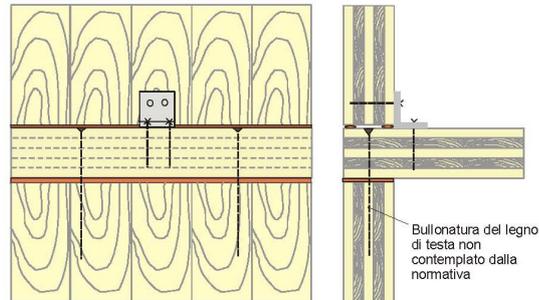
Giunzione parete-solaio-parete non realizzata a regola d'arte
